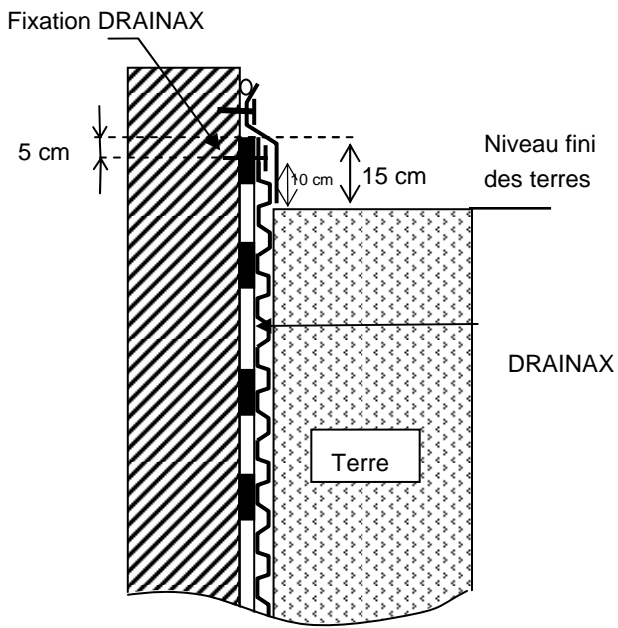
Arrêt supérieur du DRAINAX sur étanchéité
